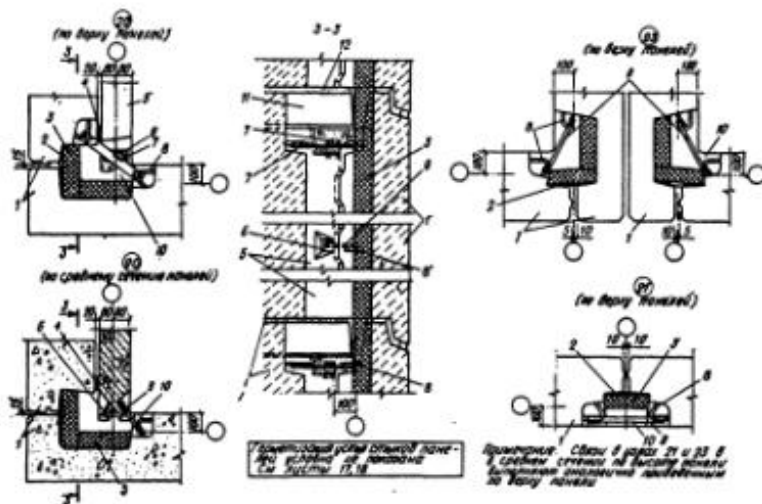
Узлы 20, 21, 23 сопряжений панелей наружных стен: 1 — панель наружной стены; 2 — воздухозащитная прокладка; 3 — утепляющий вкладыш; 4 — деревянная рейка; 5 — панель внутренней стены; 6 — закладная деталь; 7 — соединительная пластинка; 8 — петлевой арматурный выпуск; 9 — соединительный стержень; 10 — бетон замоноличивания; 12 — цементный раствор
